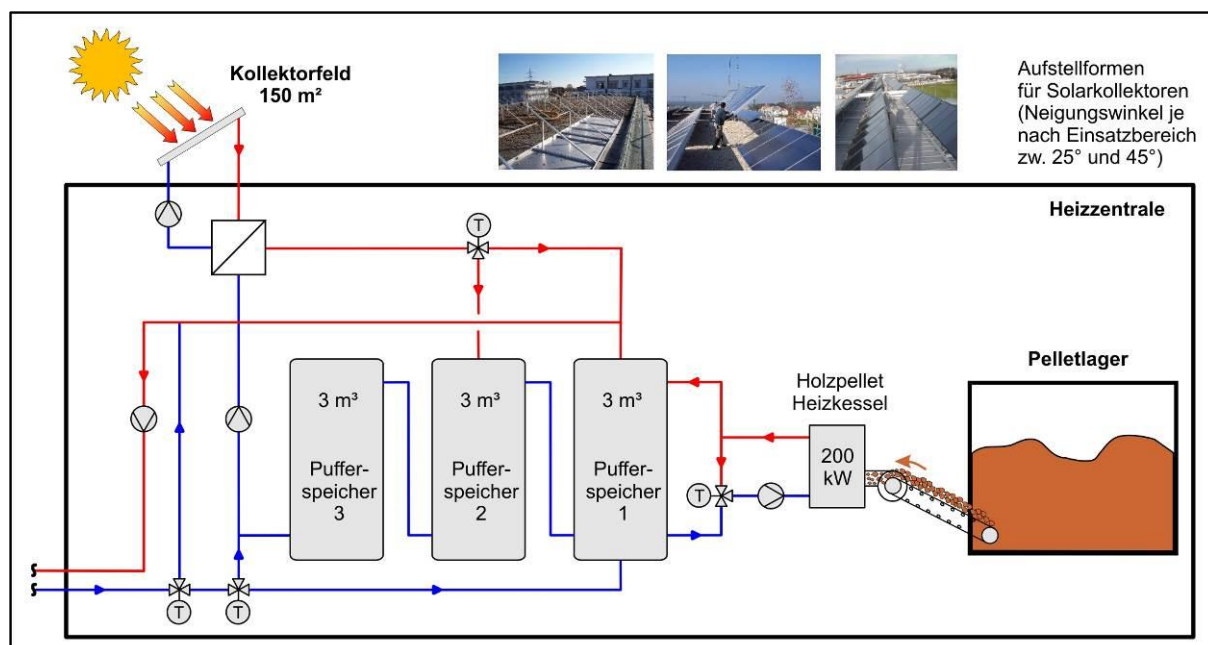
Anlagenschema Variante 7 – Holzpelletkessel mit Solaranlage 150 m²
